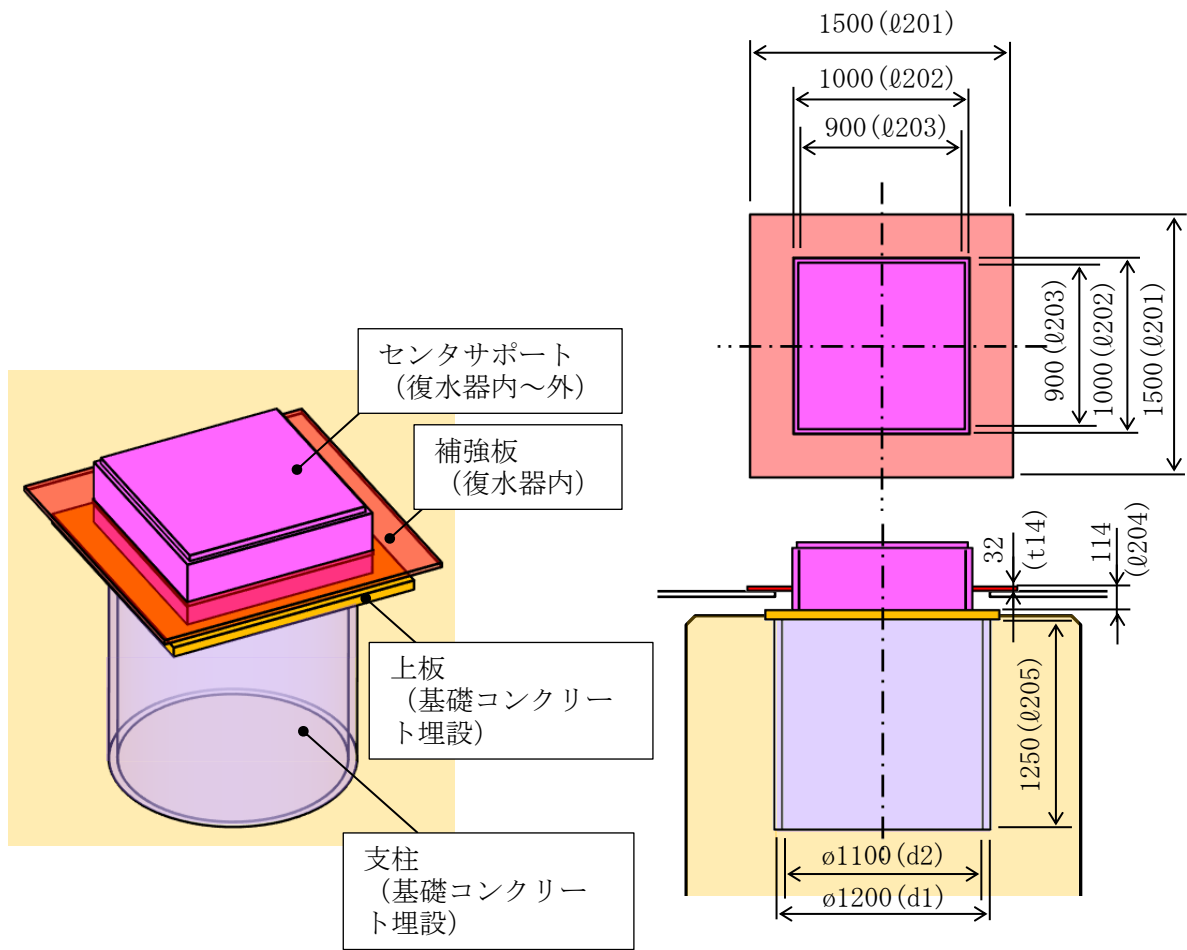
No. ⑨ センタサポート鳥瞰図, 平面図, 断面図
